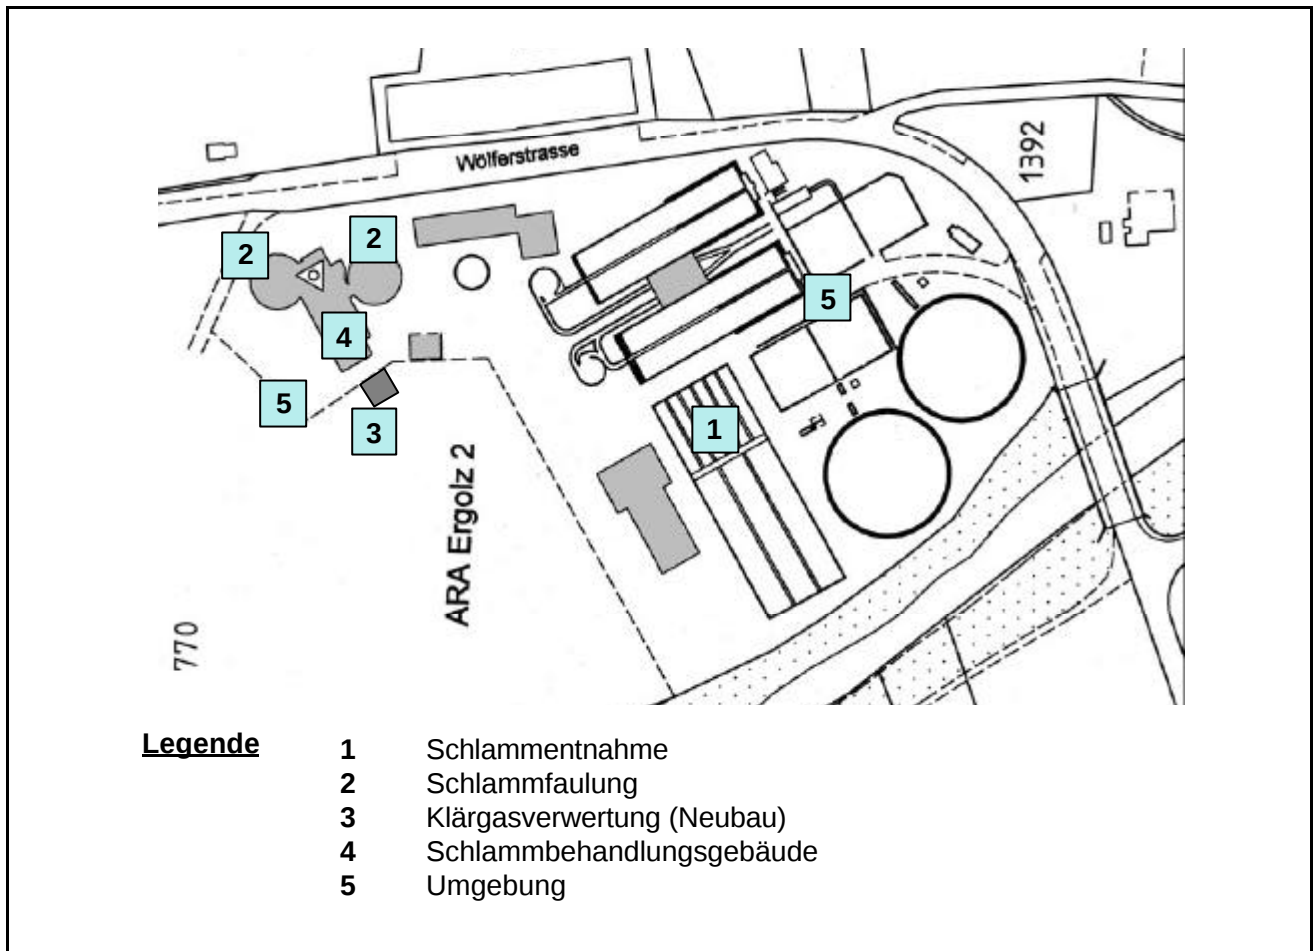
Übersichtsplan ARA Ergolz 2 mit Bauteilen für die geplanten Massnahmen
